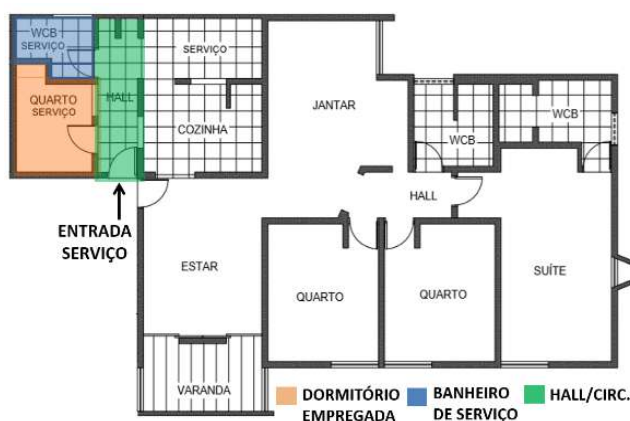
Planta baixa de unid. do Edifício Armando Lobo (1978)
